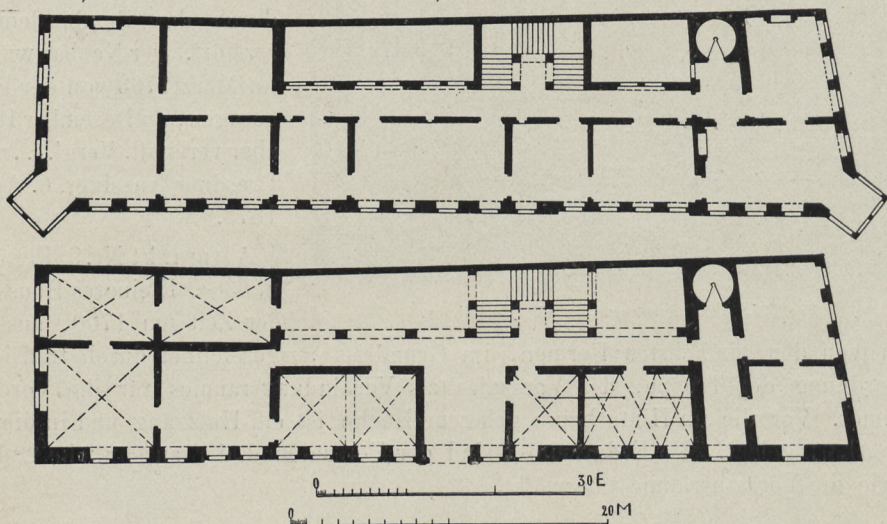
u. 538. Köckeritz'sches Haus, 1760 abgebrannt. Grundriss des Erd- und Obergeschosses.
